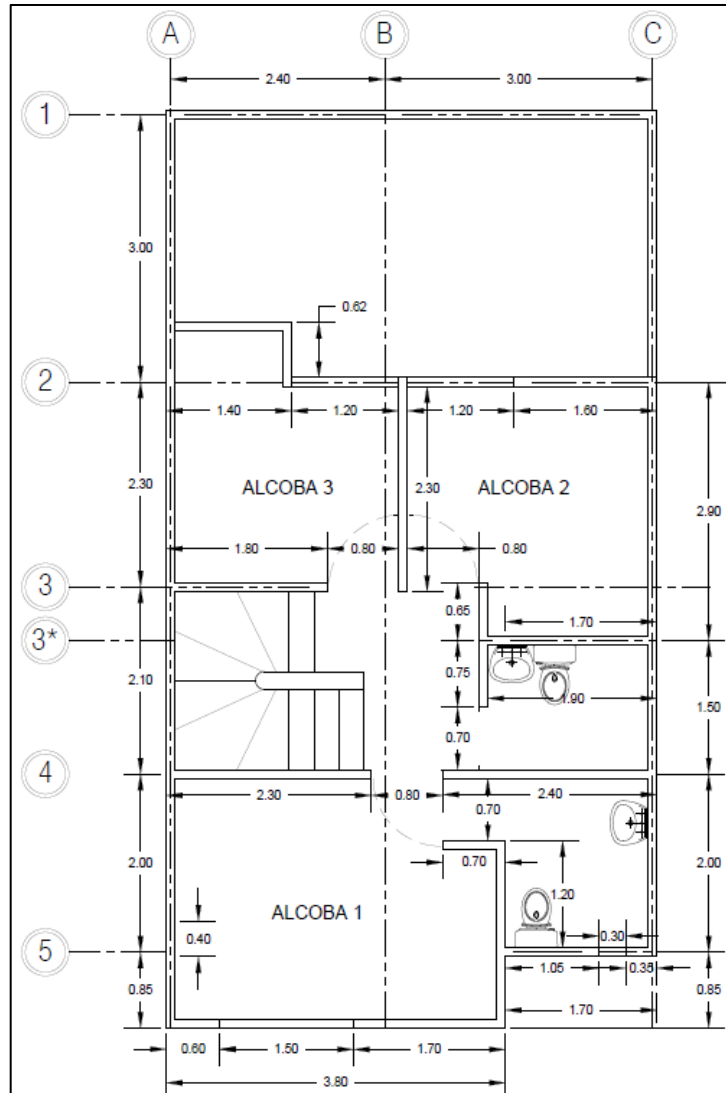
Planta arquitectónica segundo piso. Fuente: Propia.
